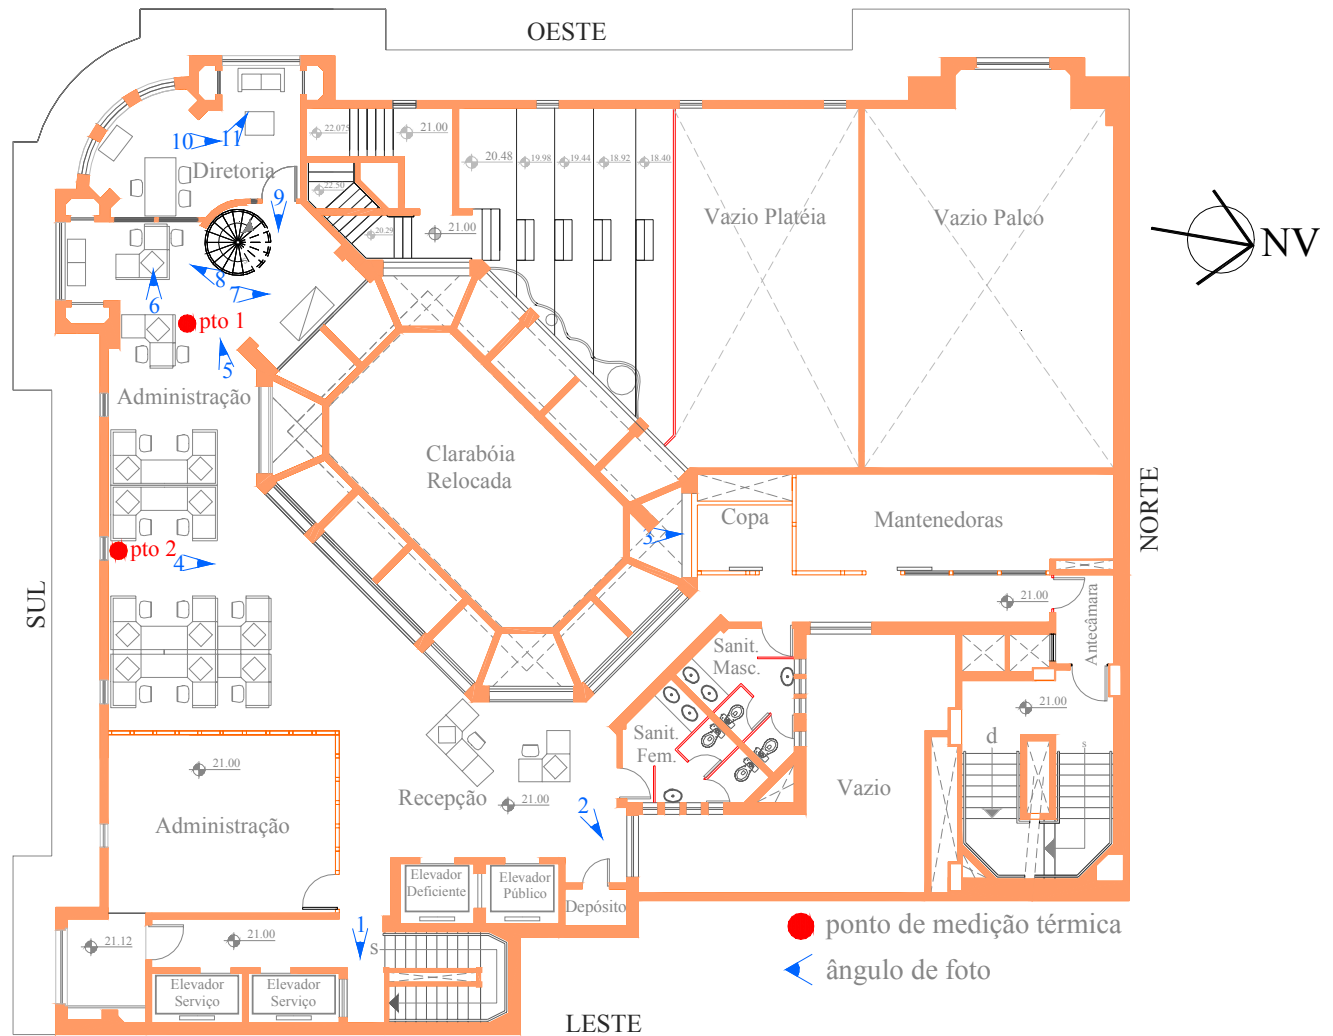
CCBB-Planta baixa – 4^o pavimento;
